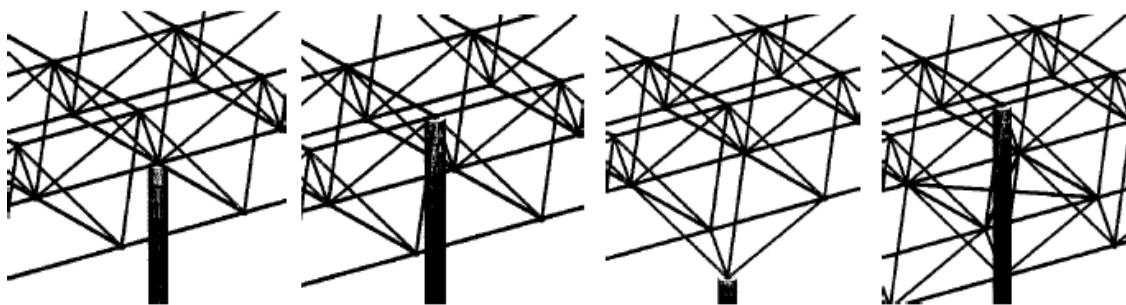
Tipos de apoios mais empregados em estruturas espaciais planas - Apoios: no banzo inferior, no banzo superior, tipo “pé-de-galinha” e tipo “engaste”.
